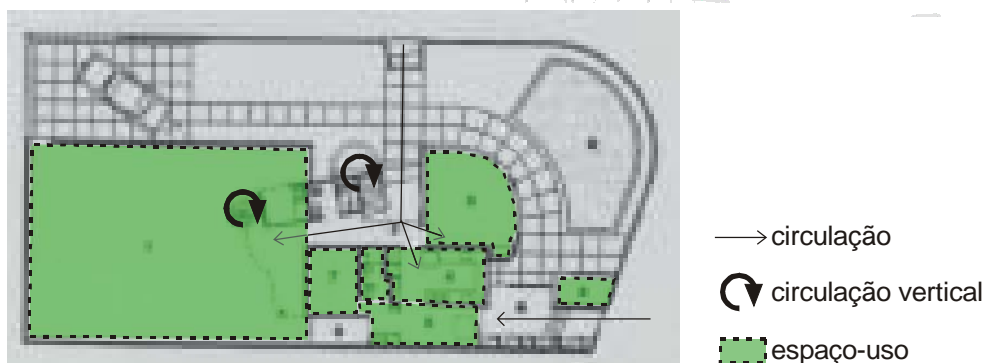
Planta do Primeiro Piso: Circulação/ Espaço-Uso
